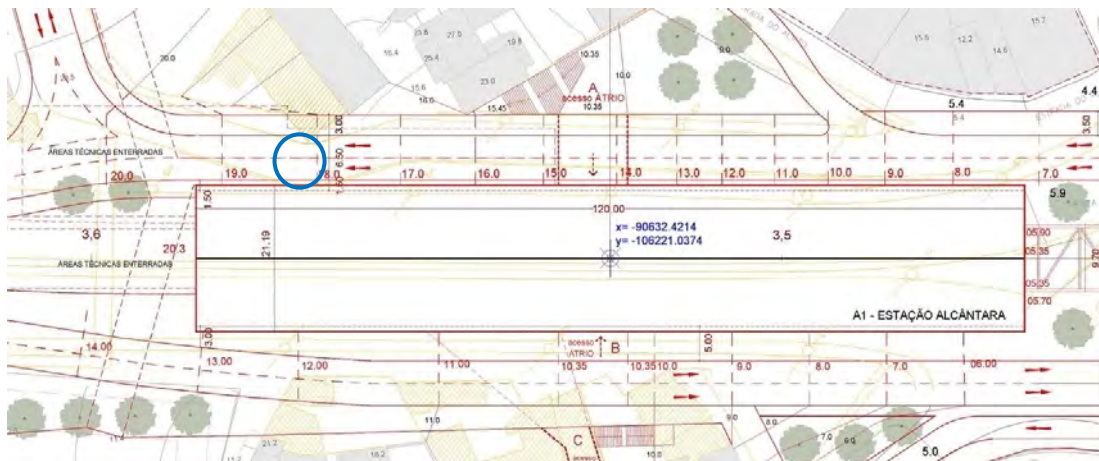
Disposição da sondagem junto à fachada exterior do edifício.
